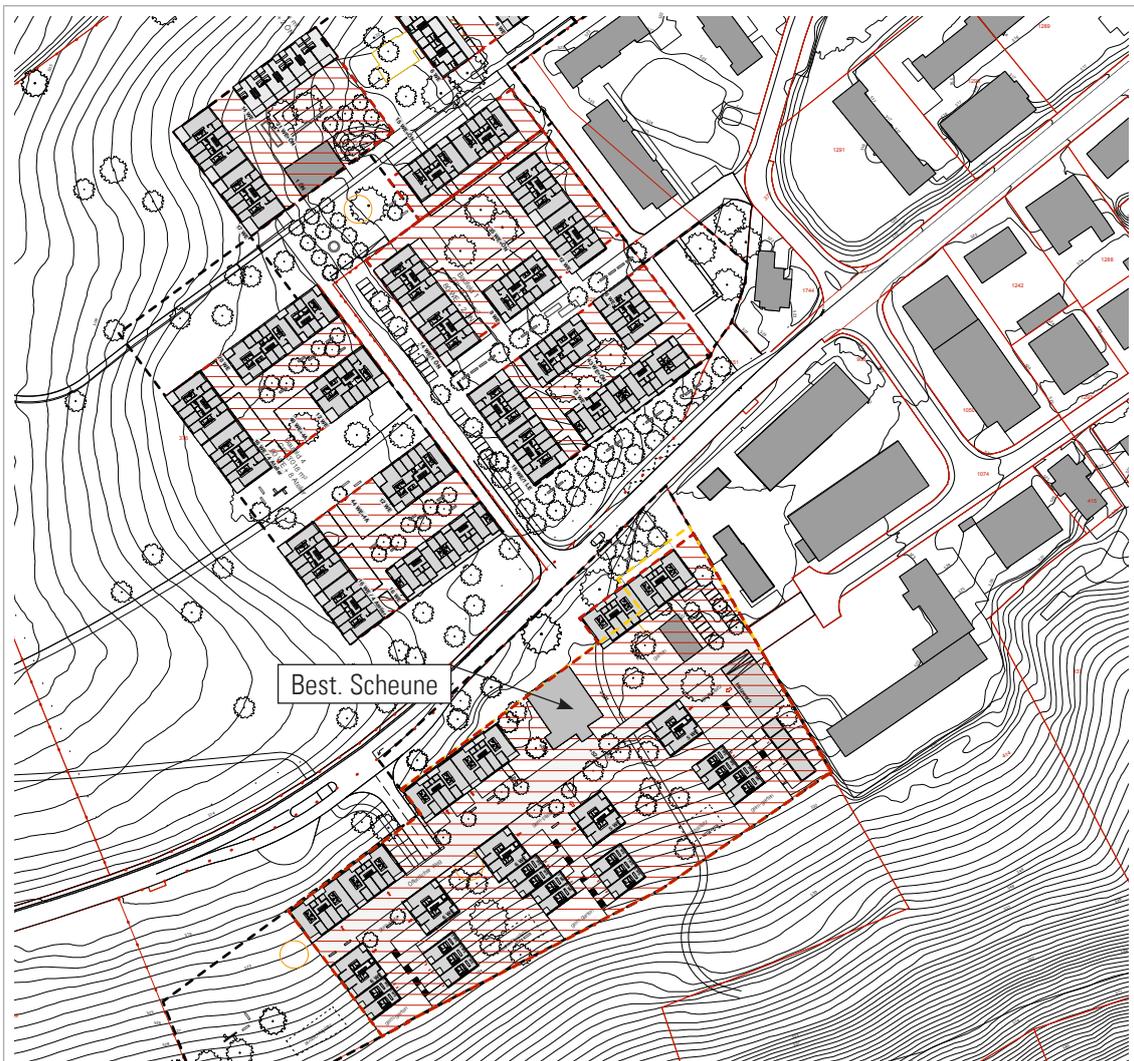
Gebäudegrundrisse aus der städtebaulichen Studie mit Anpassungen vom Mai 2016
